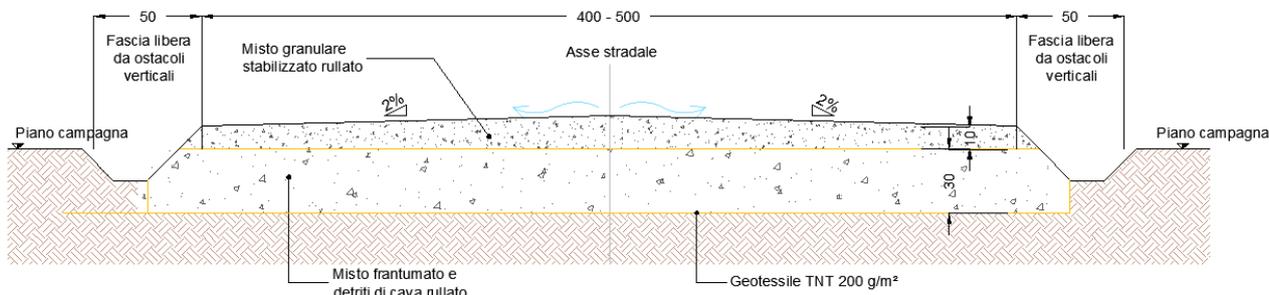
Sezione tipo pista di impianto; misure in centimetri
